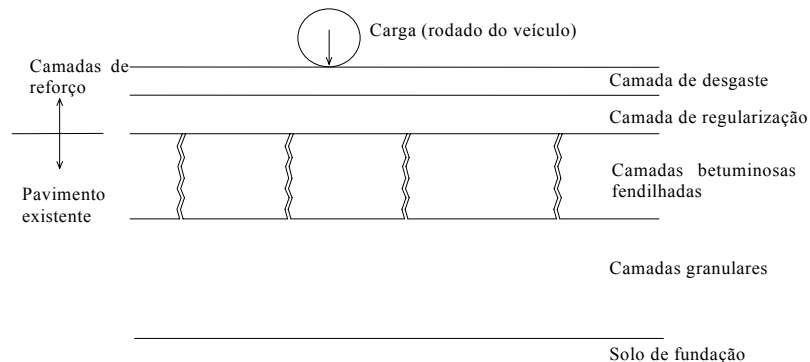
Representação esquemática da estrutura do pavimento após reforço
